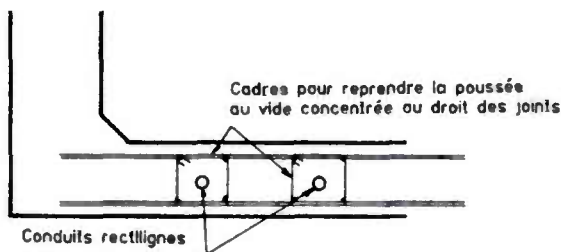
Proposition de ferrailage reprenant les poussées au vide accidentelles au droit des joints
